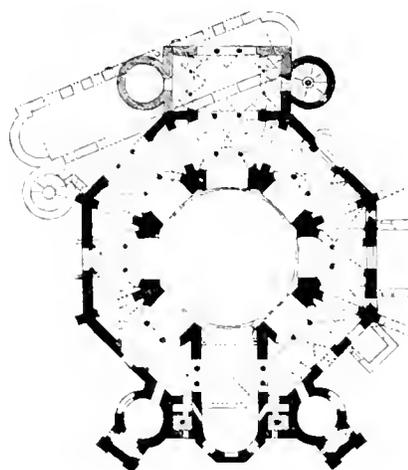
Grundriss von San Vitale in Ravenna.
